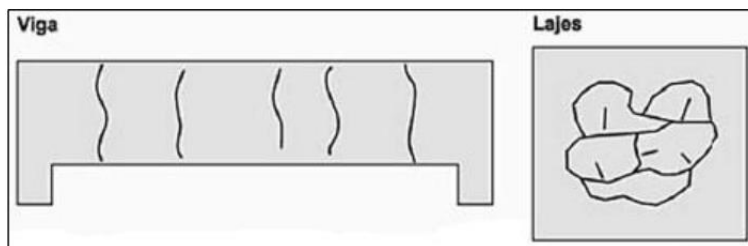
Tipos e incidência de fissuras em concreto armado.
